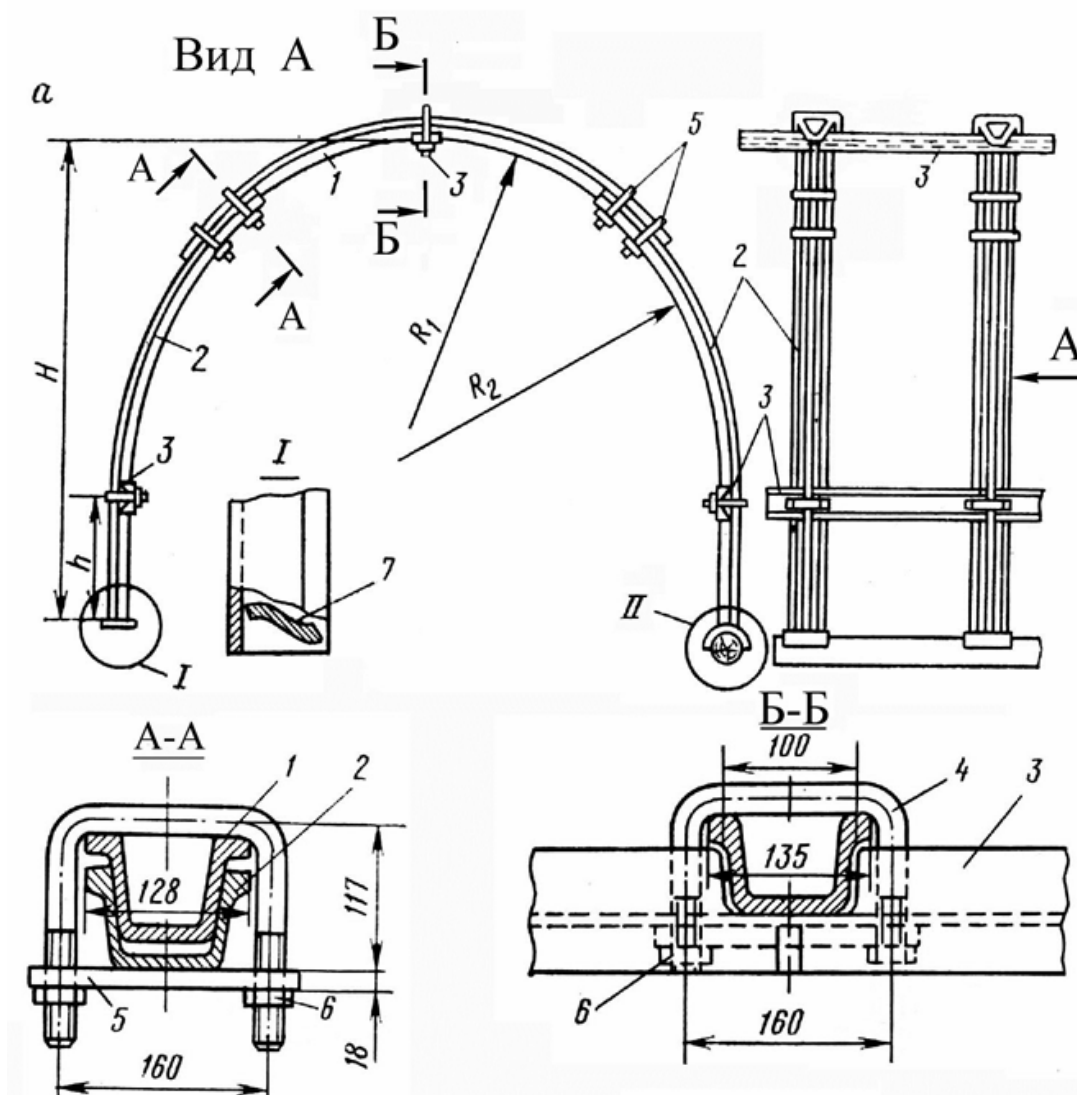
Металлическая арочная податливая крепь АП-3 из спецпрофиля: 1 – верхняк; 2 – стойка; 3 – стяжка; 4 – скоба; 5 – планка; 6 – гайка; 7 – диафрагма.
